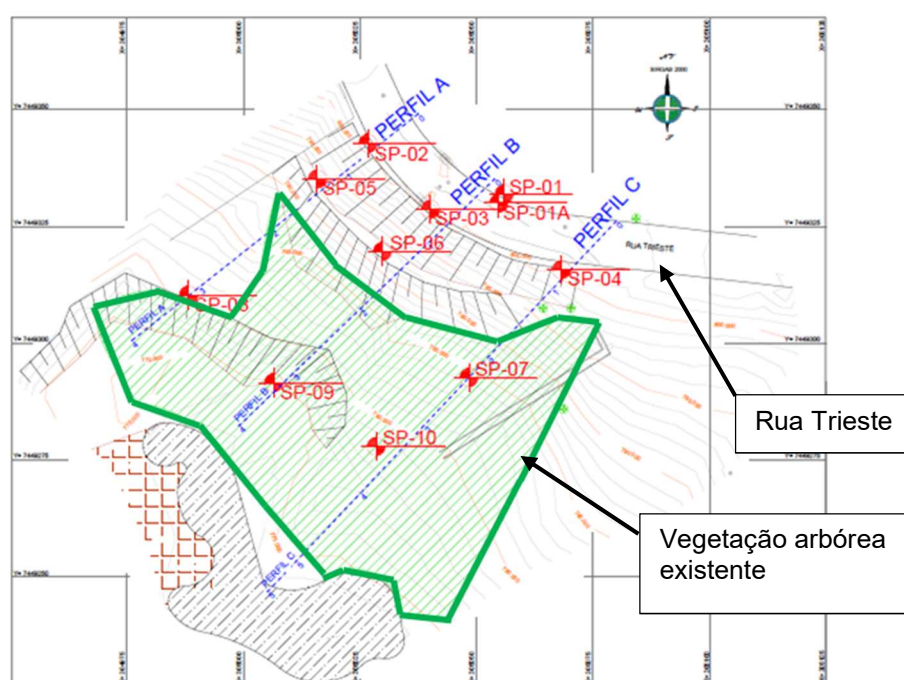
Localização dos perfis geotécnicos “A” a “C” em planta.
